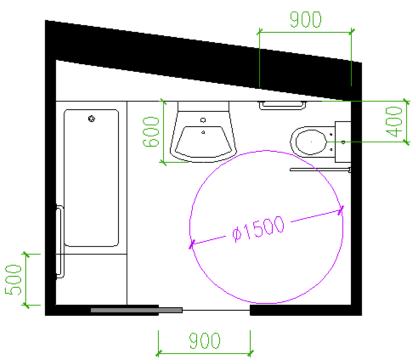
Detalle del baño adaptado de la planta superior de la vivienda.
